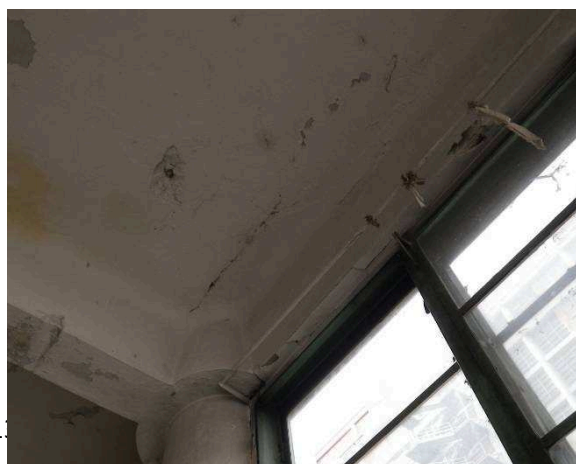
narušení krycích vrstev betonu na stropním trámu v 1.NP – nahnědlá barva betonu charakteristická pro hlinitanové betony
